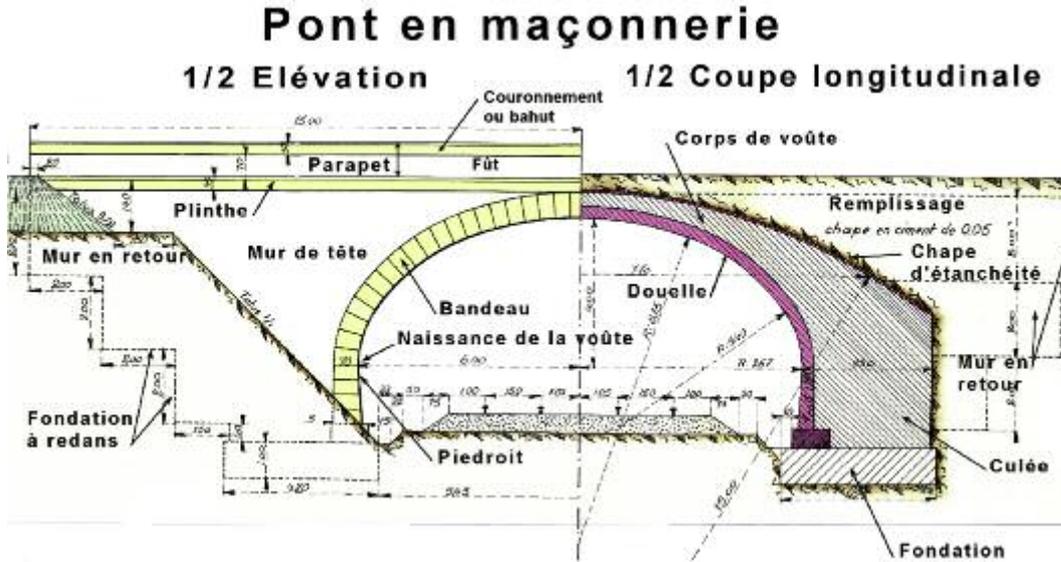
demi-élévation et demi-coupe longitudinale d'un pont en maçonnerie
